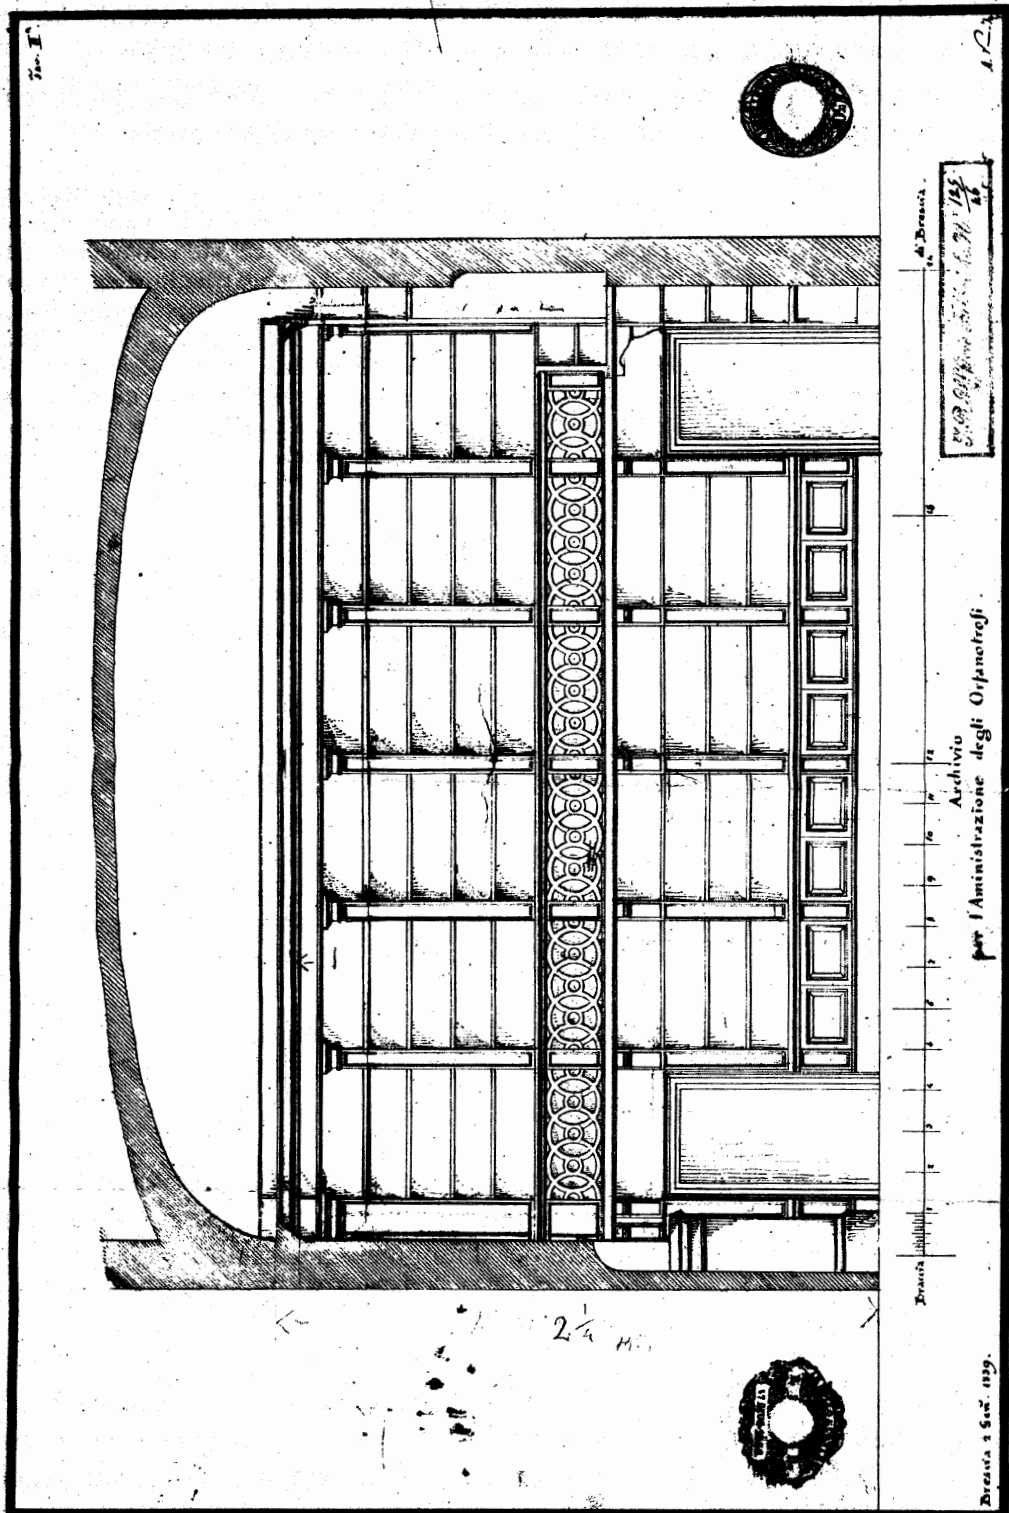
R. Vantini, Sezione della parete lunga della sala dell'archivio con prospetto delle scaffalature, Brescia 2 gennaio 1839, 325x457, matita, penna, inchiostro nero,
